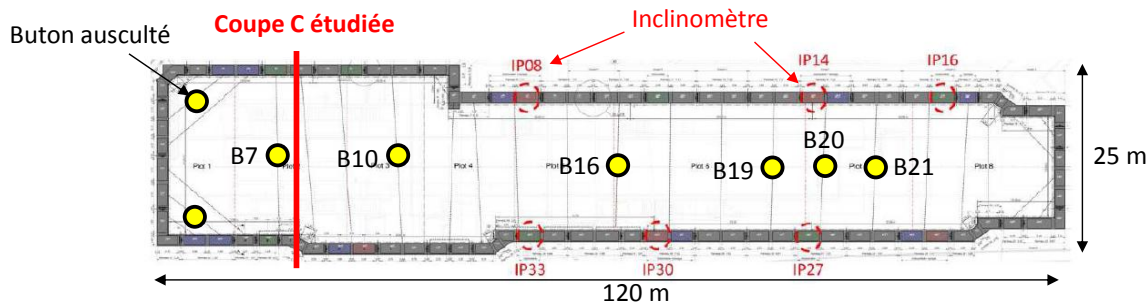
Vue en plan de la gare KBH avec l'instrumentation en place et la coupe C étudiée
